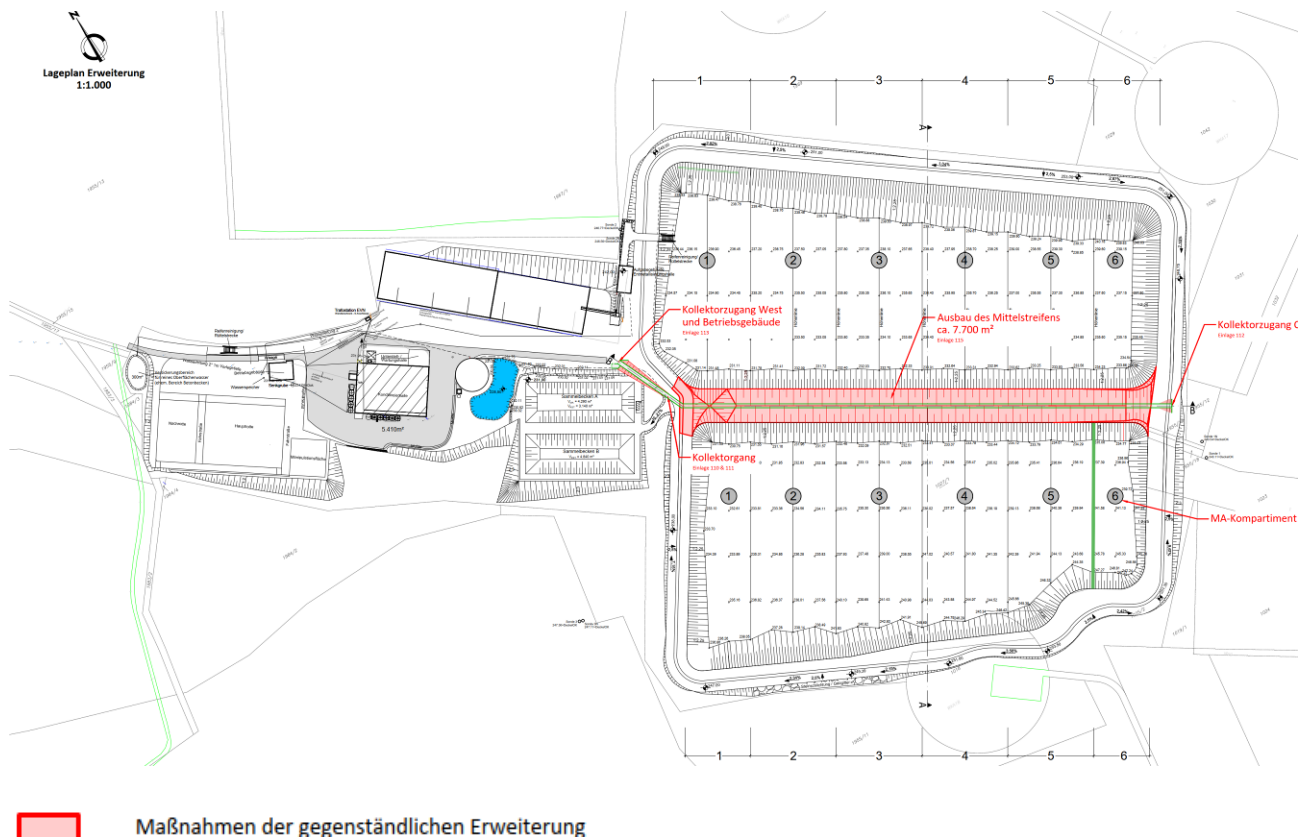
Lageplan ggst. Vorhaben (Quelle: Einreichoperat, Einlage 105)
